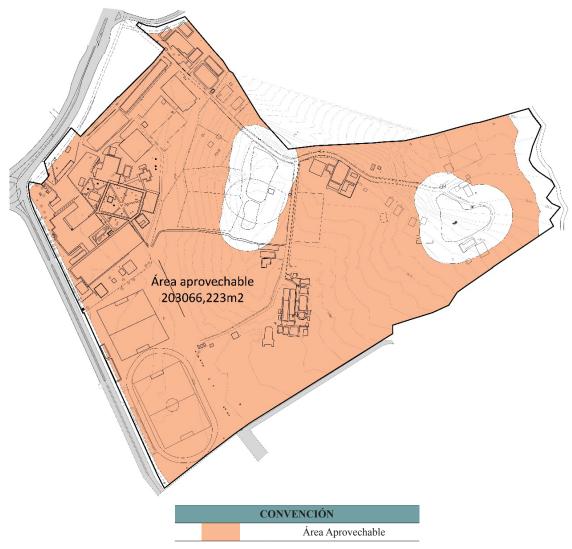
Área aprovechable del predio. Fuente: Elaboración propia (13.12.2016)
